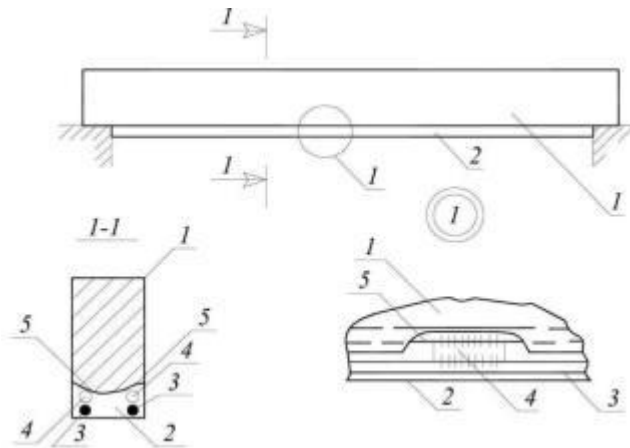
Нарощування балок у розтягнутій зоні при незначній величині їхньої несучої здатності: 1 – балка, що посилюється; 2 – залізобетонне нарощування; 3 – поздовжня арматура посилення; 4 – арматурні коротиші; 5 – оголена арматура балки (ділянки із кроком через 1.0м)
